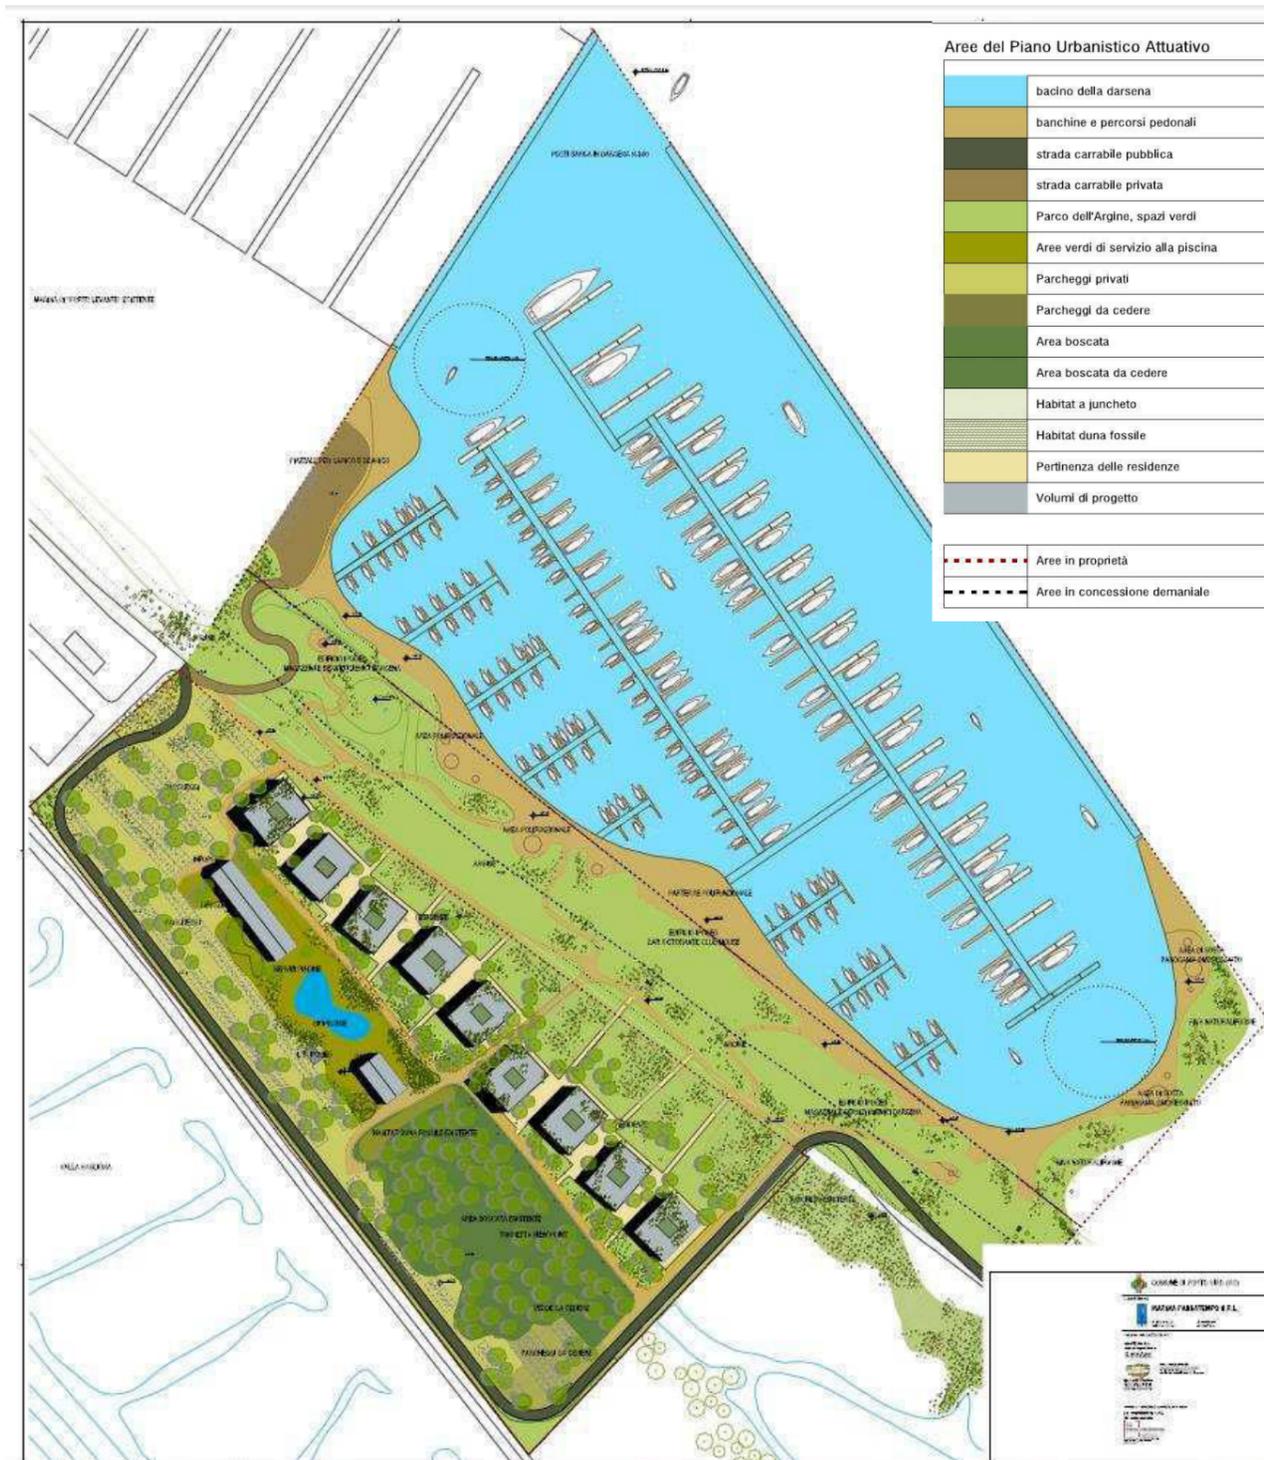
Planivolumetrico dell'area oggetto del nuovo Piano Urbanistico Attuativo
